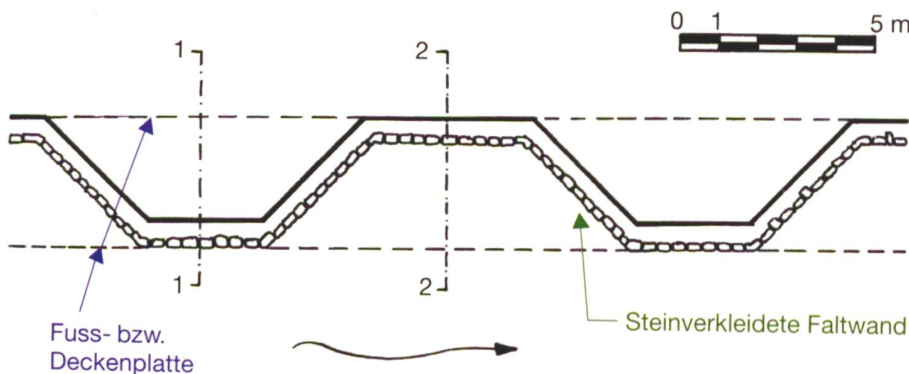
Situation einer trapezförmigen Faltkastenmauer (Neigung 45°, Baubreite 3,25 m, Wandstärke 0,6 m).
